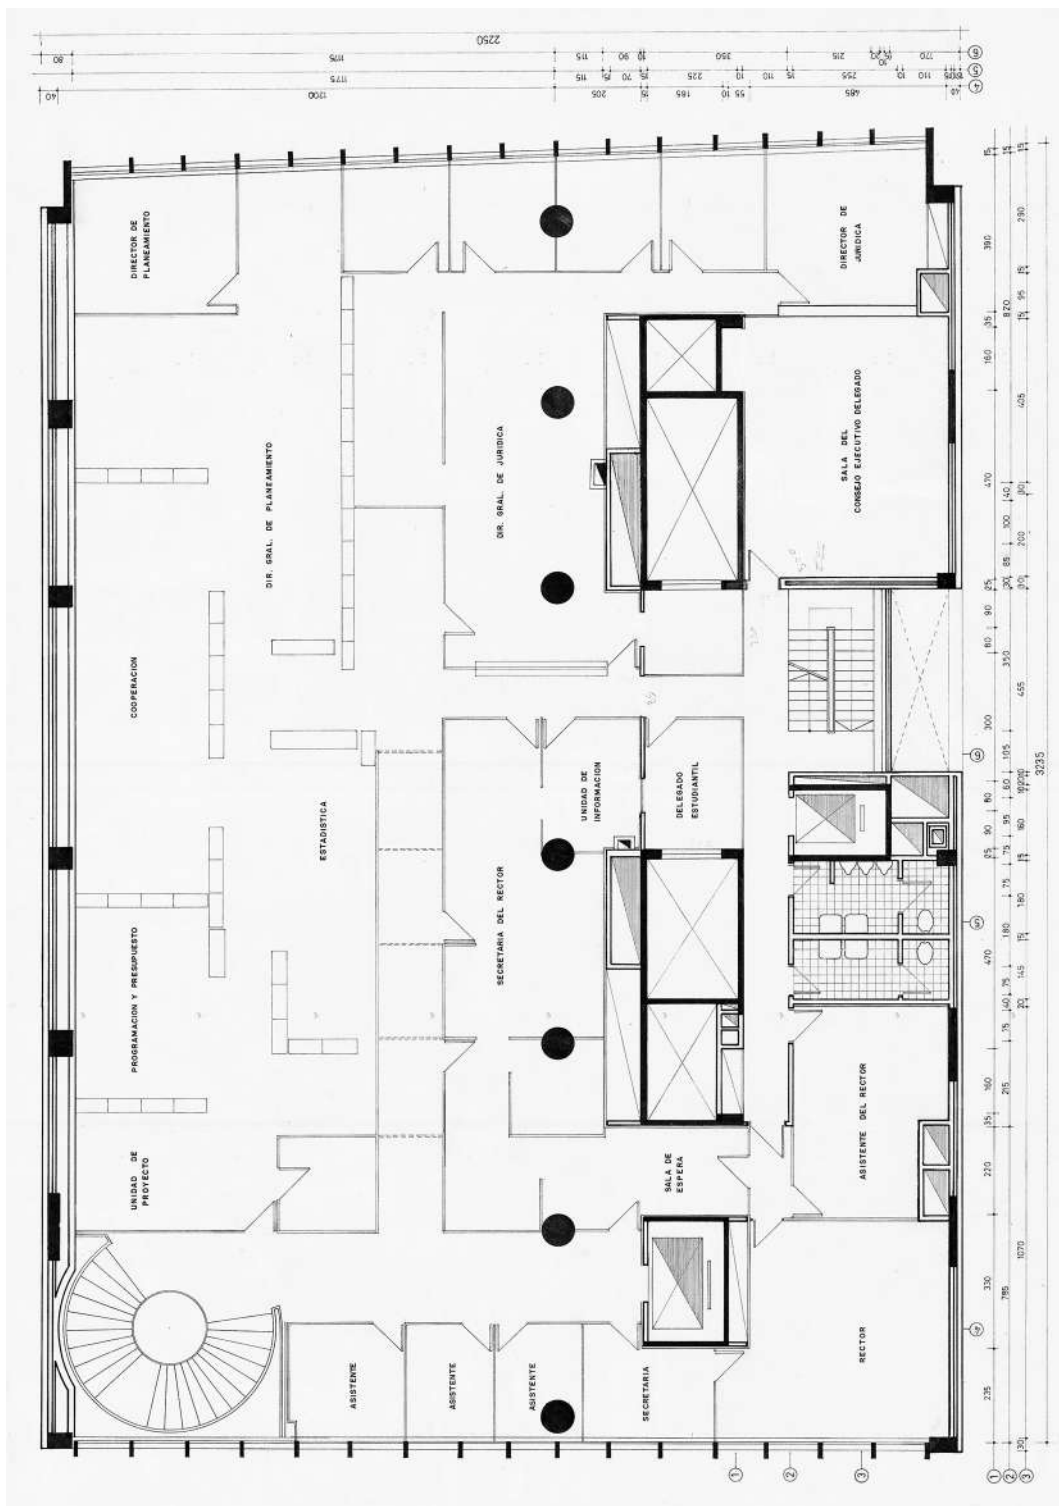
Planta de relevamiento del segundo piso del BCLA levantada por la *UdelaR* en 1976. Obsérvese la notoria compartimentación de la planta libre.
